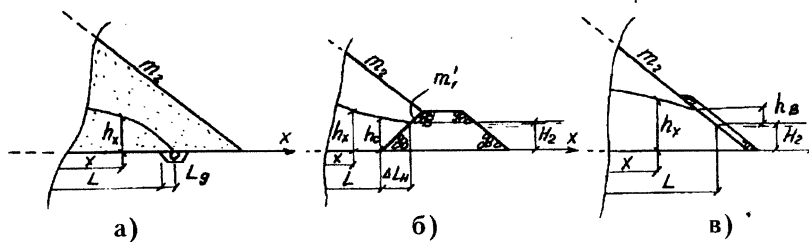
Расчетные схемы дренажей: а) трубчатый; б) дренажный банкет; в) наклонный.
